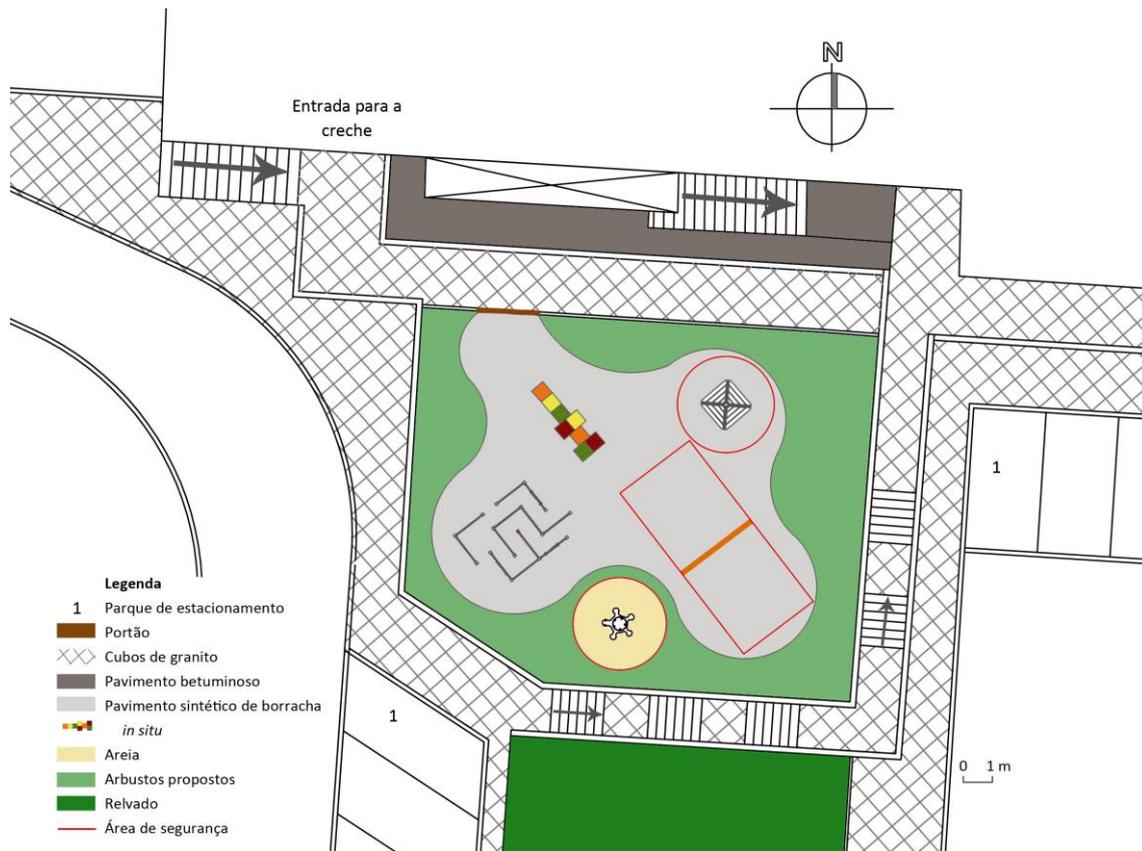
Planta geral da proposta do espaço de recreio associado à creche. (Planta elaborada pela autora)
